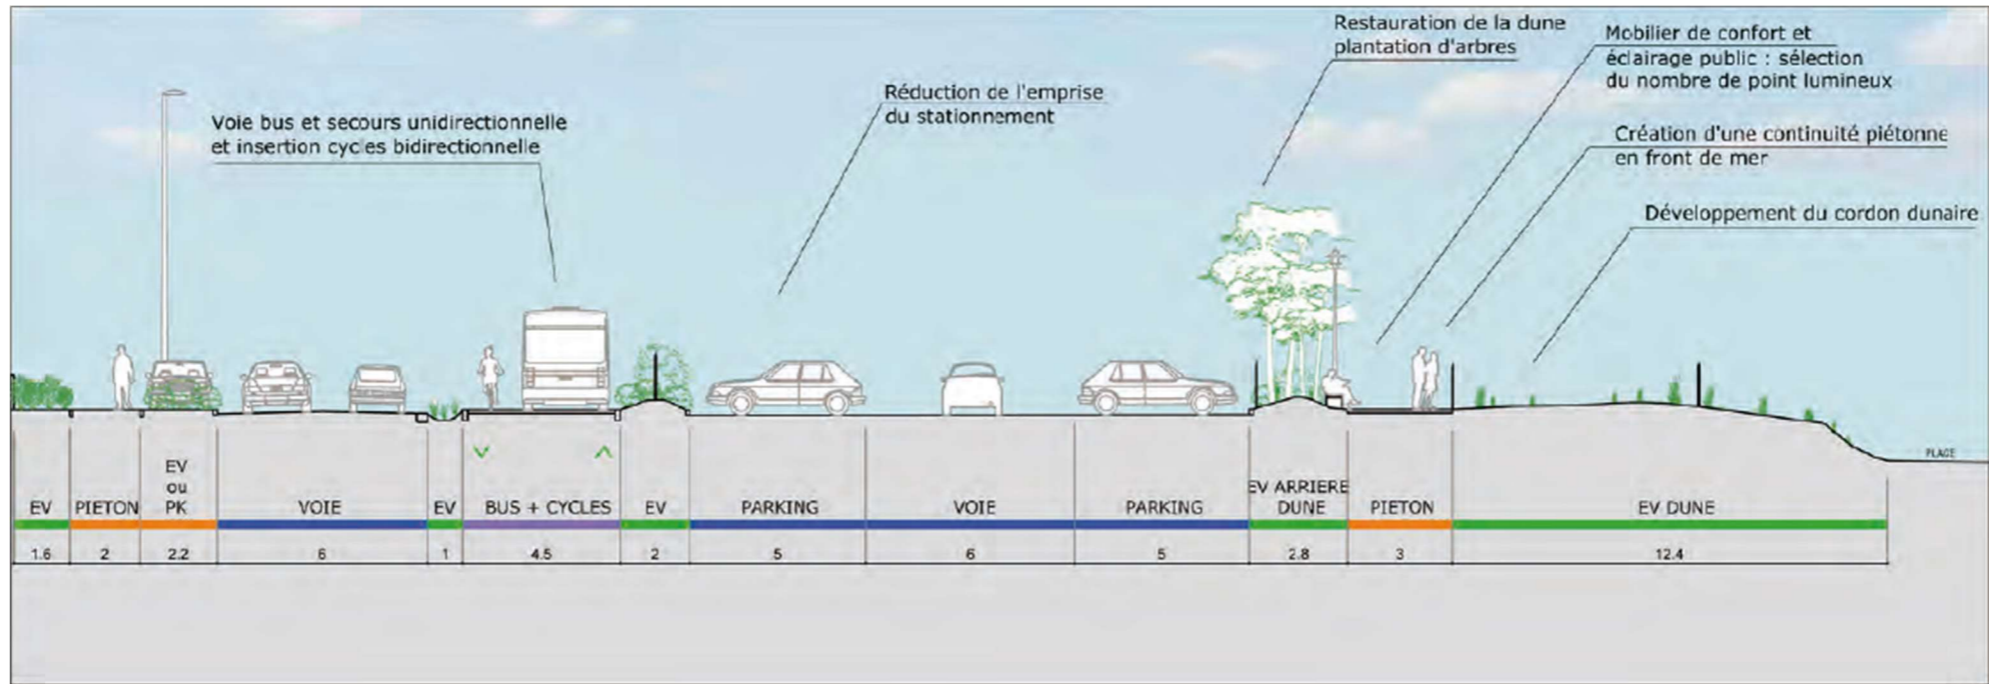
Coupe de principe avenue des dunes – stationnement à proximité du poste de secours - du projet d'aménagement « 2. Aménagement du site propre et requalification de la plage sud de Rivedoux »
